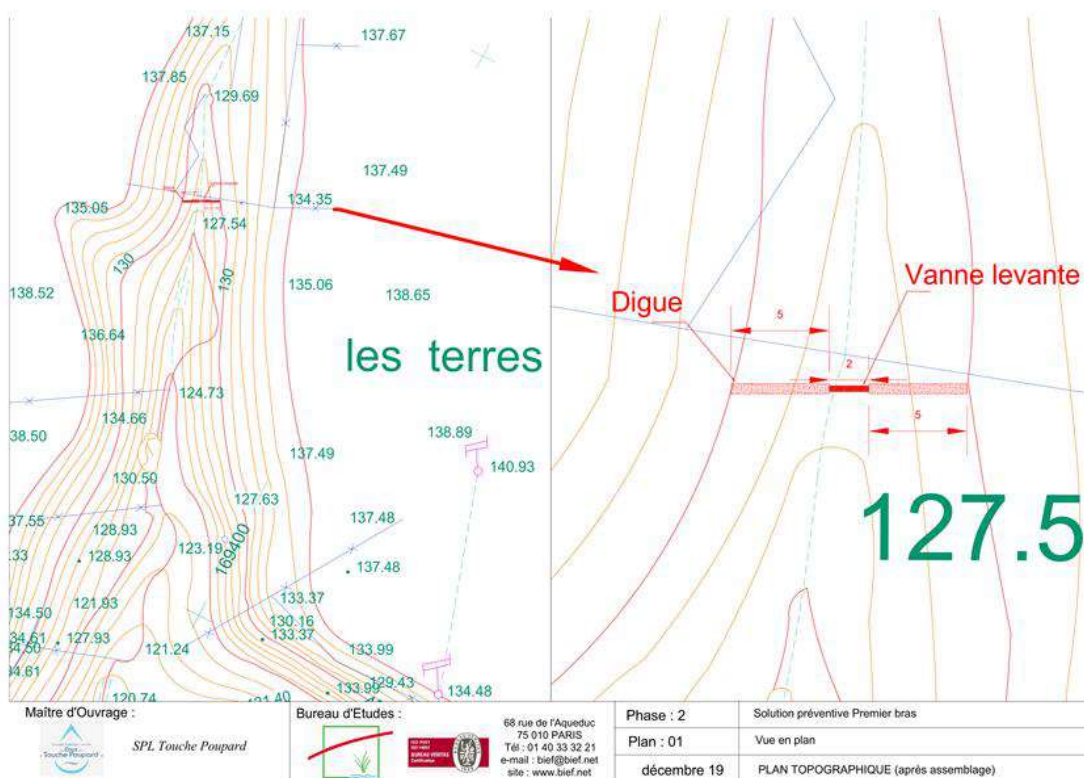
Vue en plan du scénario préventif au niveau de la zone du premier bras
